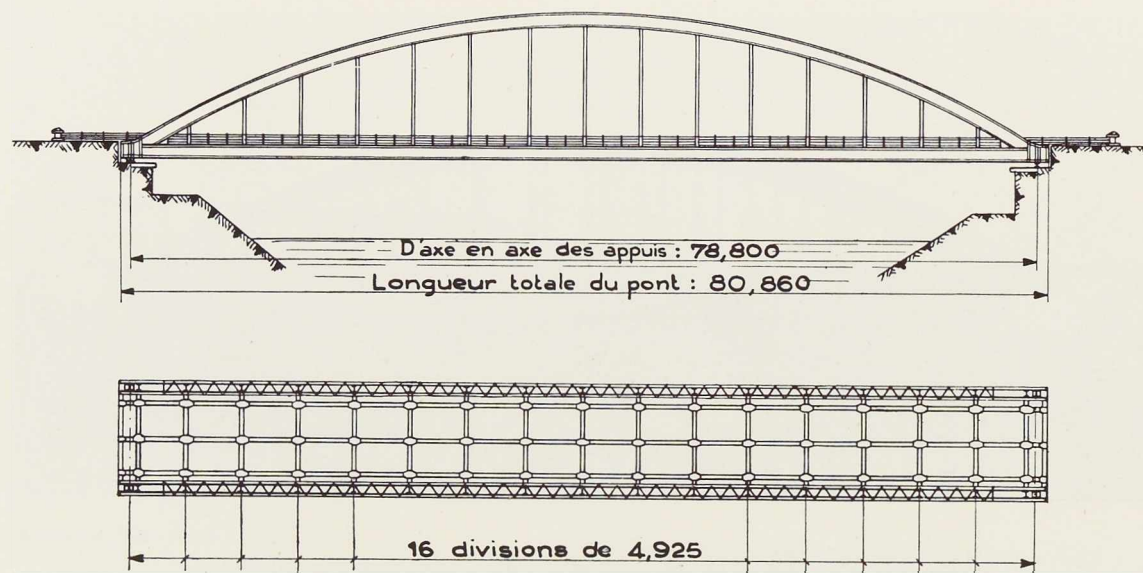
Elévation et plan du pont-route de Jaulgonne sur la Marne.
